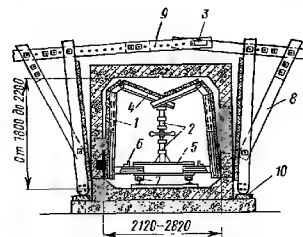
Катучая опалубка для бетонирования прямоугольного туннеля (разрез):
